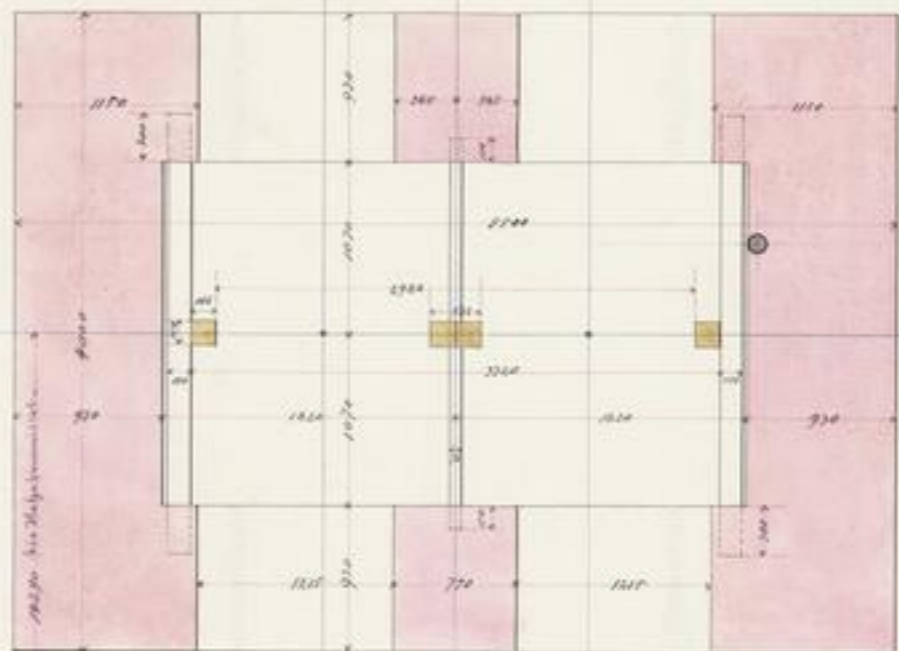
Grundriss durch das ganze Streckwerk.
